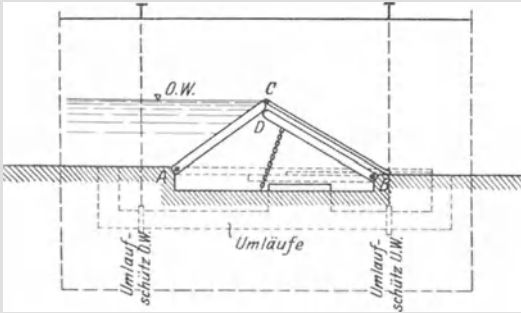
Selbsttätiges Doppelklappenwehr mit Geschiebenschutzdeckklappe.
